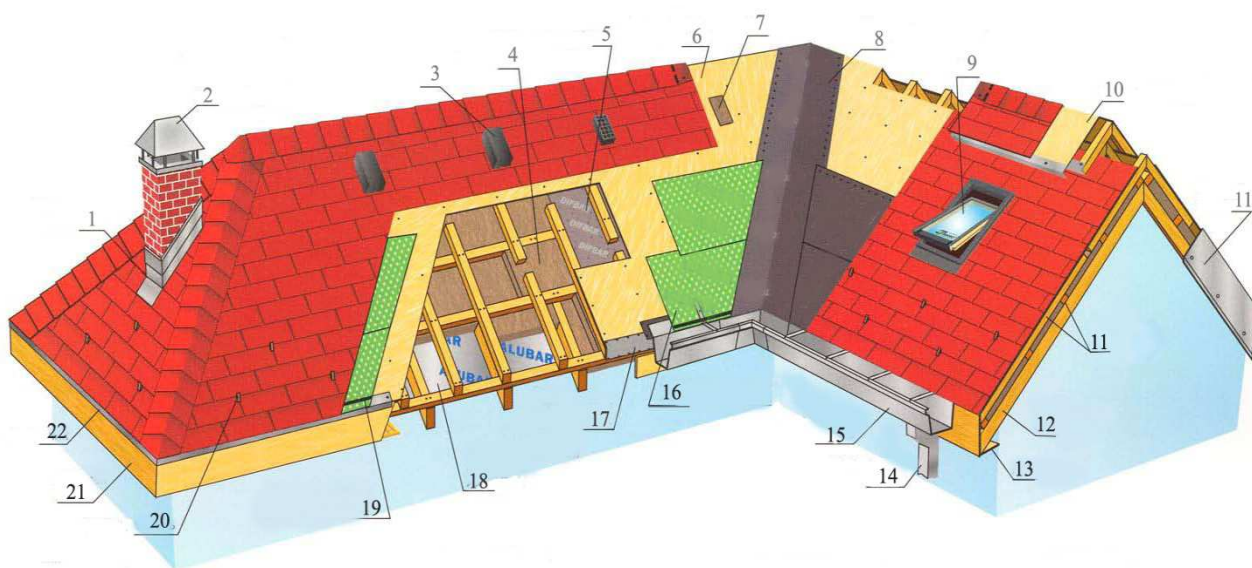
Общая схема укладки гидроизоляционной подкровельной плёнки и битумно полимерной черепицы на крыше:
